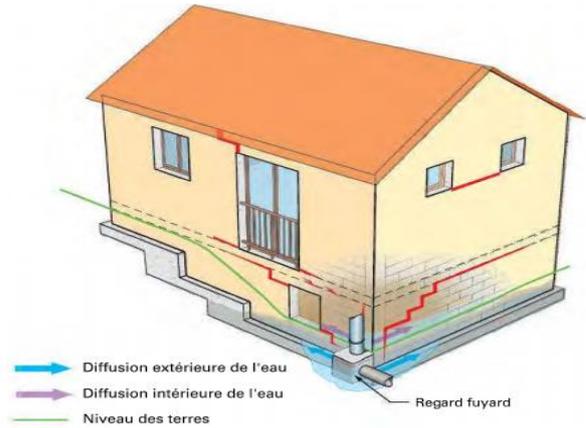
Schéma de la diffusion de l'eau le long de la fondation
